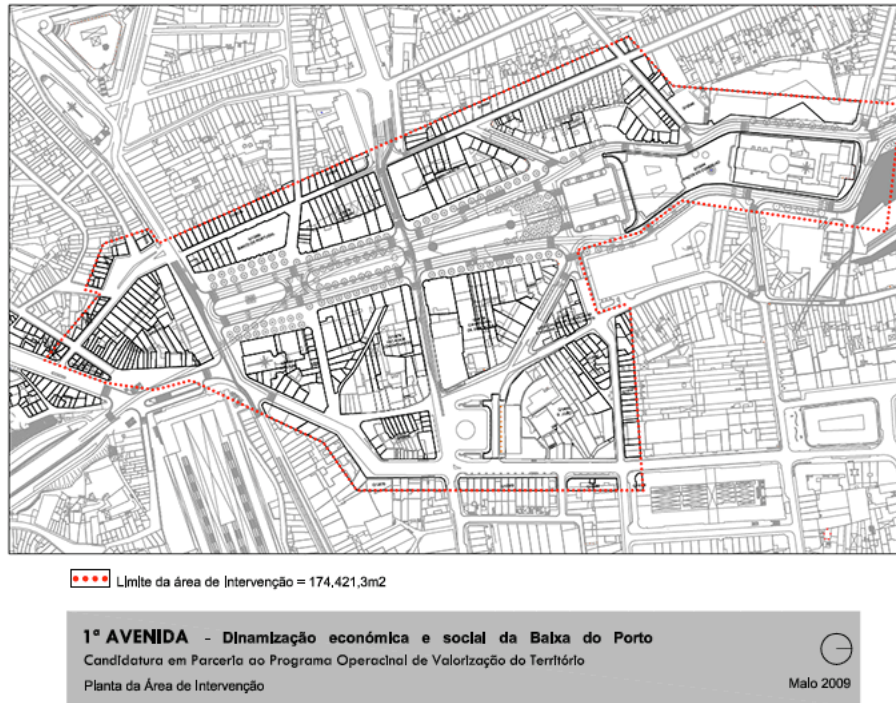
Planta da área de intervenção do Projeto 1ª Avenida [13]
